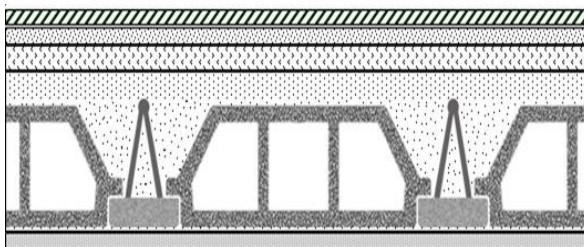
Coupe verticale du plancher courant à corps creux.
